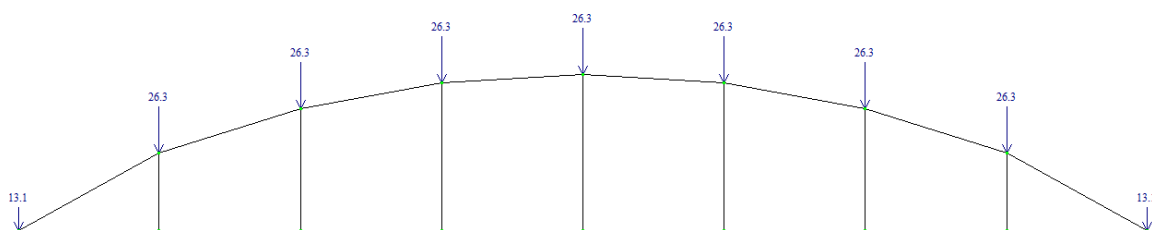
Розрахункова схема без розкісної ферми від снігового навантаження
